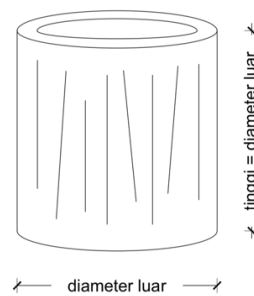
Bentuk Benda Uji Kuat Tekan Beton
